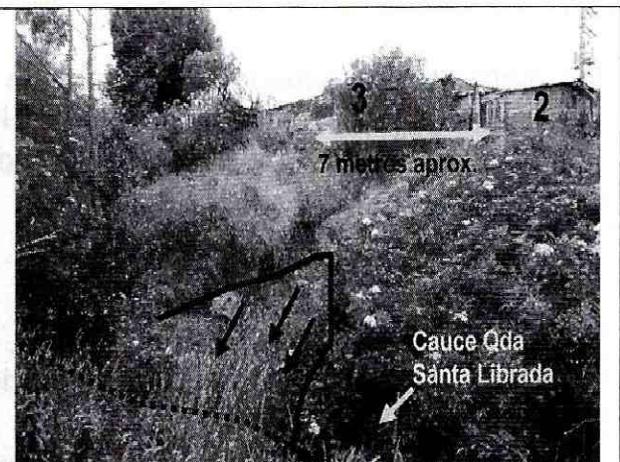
Predio de la Calle 76 Sur No. 12-94 Este (1)
